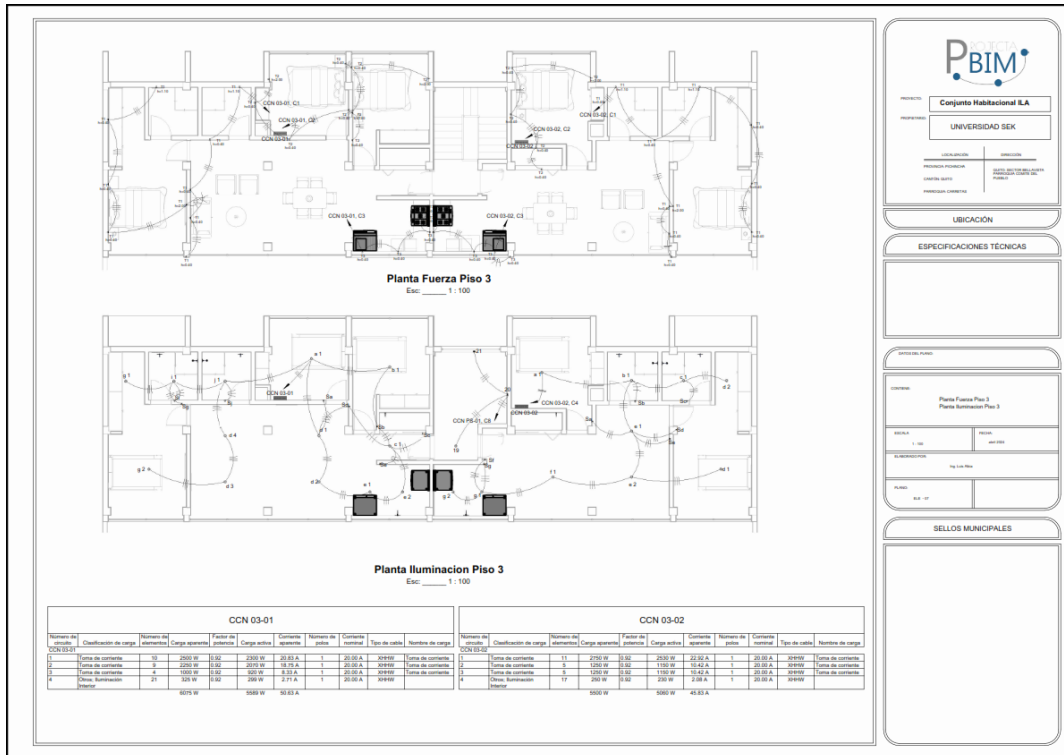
Plano Eléctrico Fuerza e Iluminación Piso 3 B1
